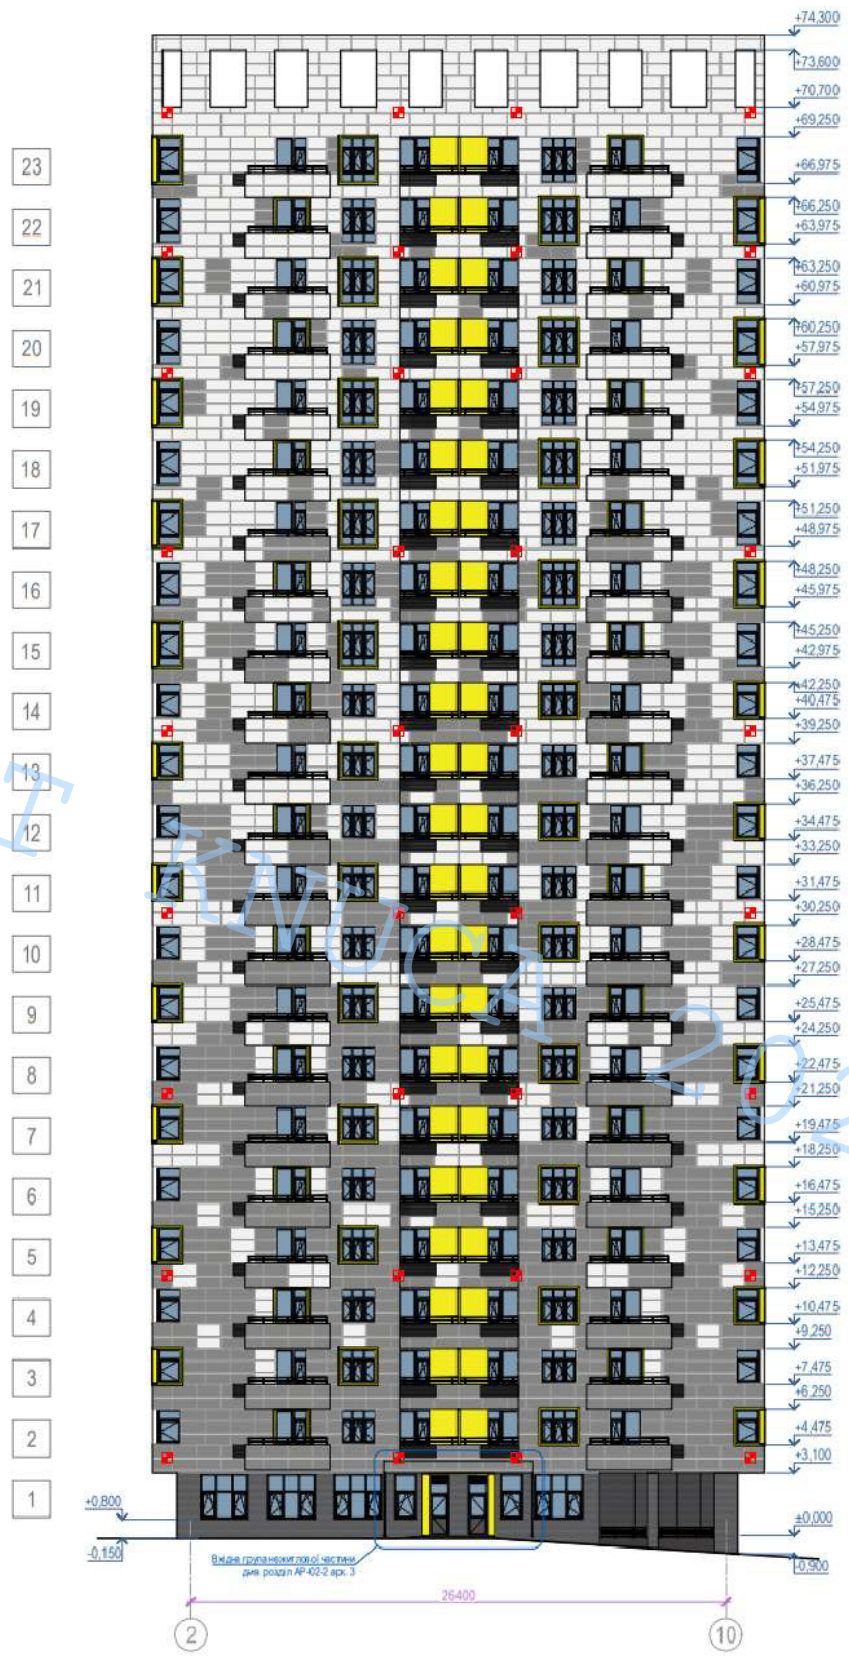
Проект закріплення марок та тріпельпризм на фасаді будівлі по осях
